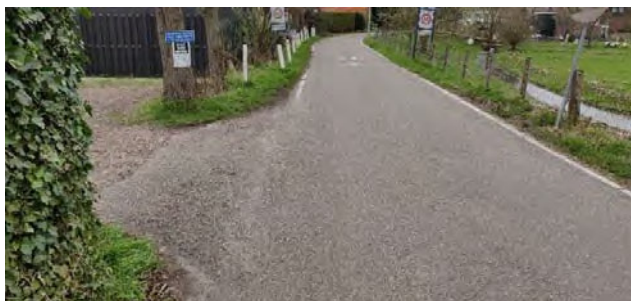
V33 Inrit thb overkant Lange Stammerdijk 45
